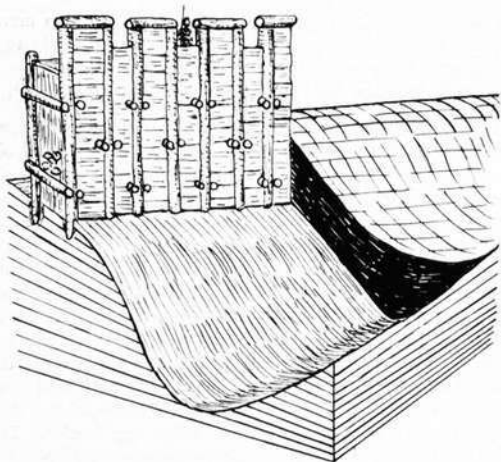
Vorgeschichtliche Wehrmauer mit Wallverfallsstadium rechts.
